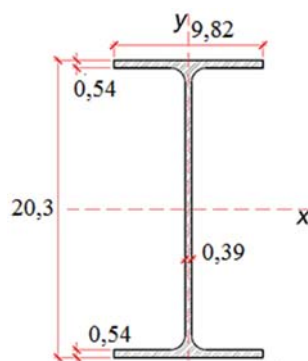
Dimensões dos perfis metálicos em centímetros
